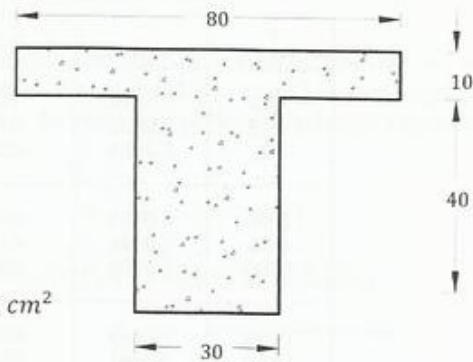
Viga T en estudio (Ejemplo 5.17)
